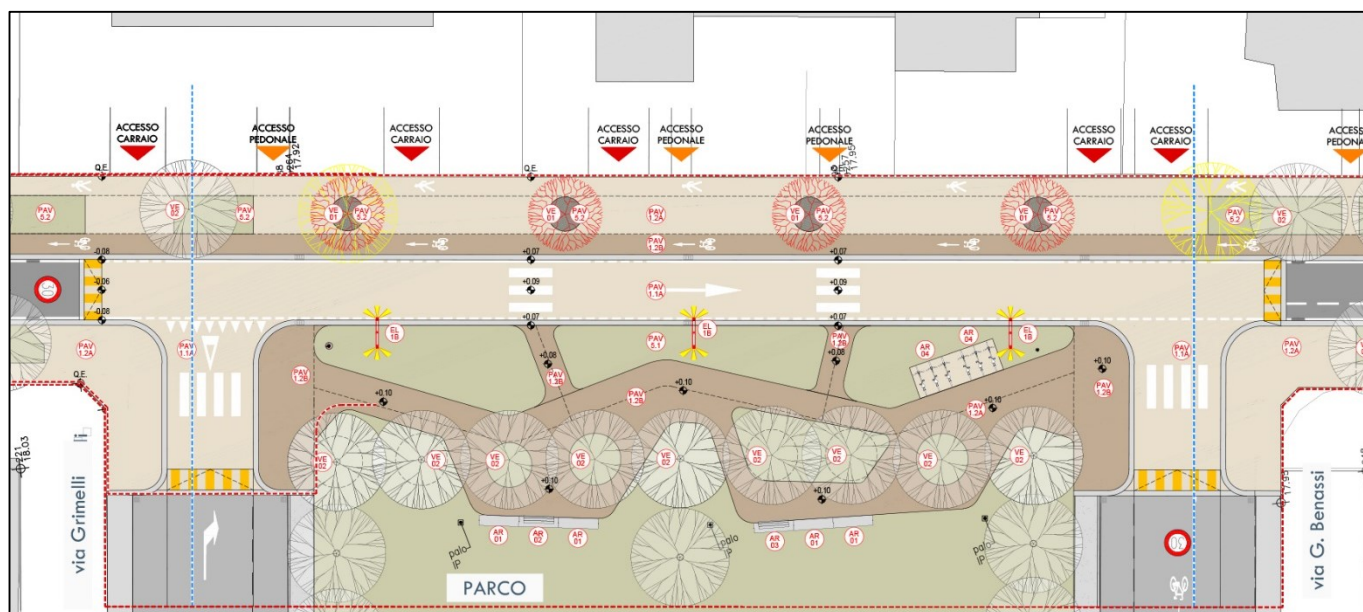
elaborato di progetto - stralcio d'intervento n°3
